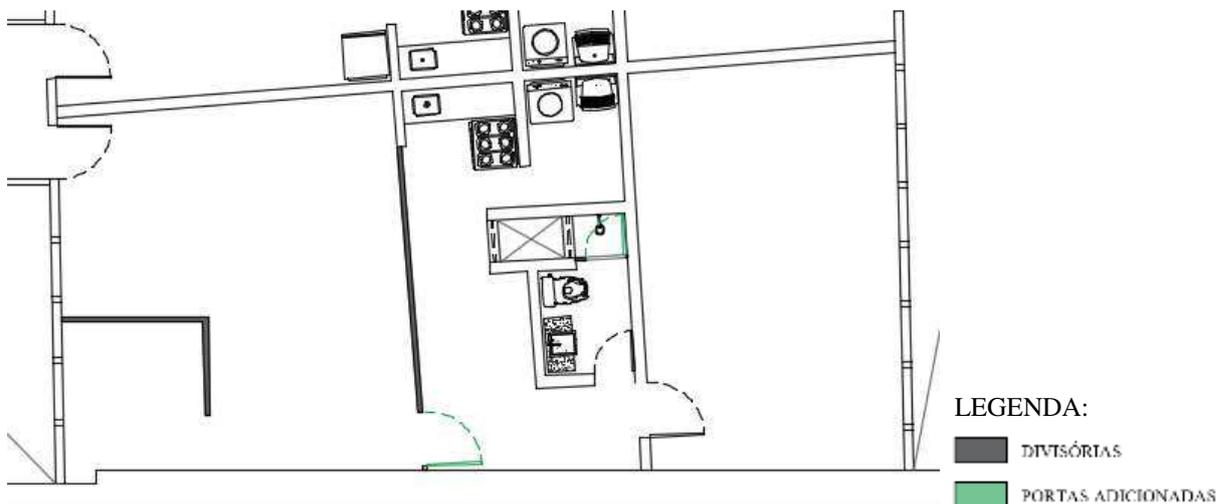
Modificações sofridas na planta da unidade nº 8.
